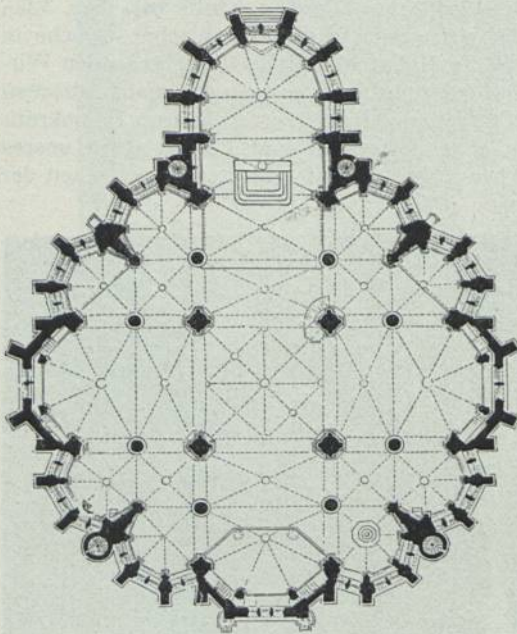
Grundriss der Liebfrauenkirche zu Trier
